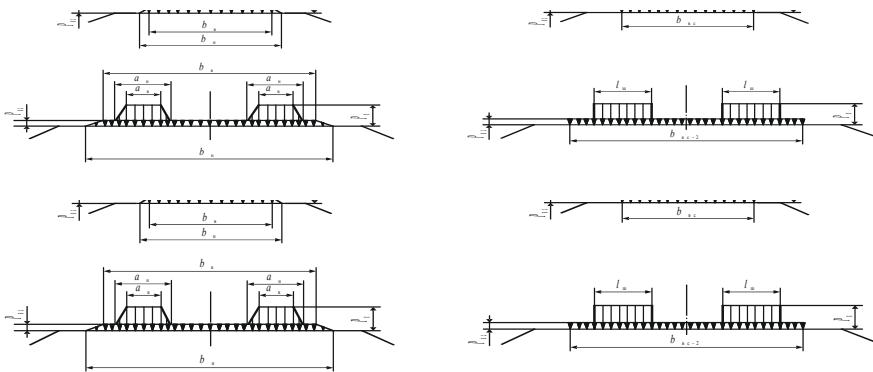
Схемы внешних нагрузок на расчетную плоскость (основную площадку земляного полотна):
